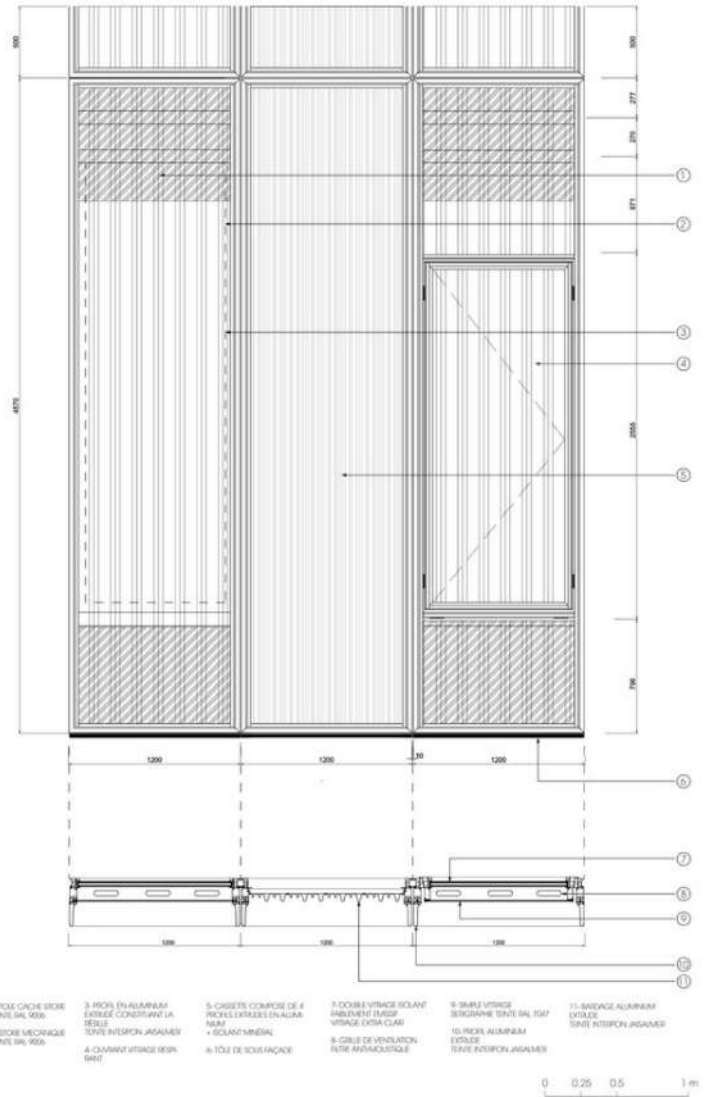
Detalle arquitectónico del elemento del proyecto.
